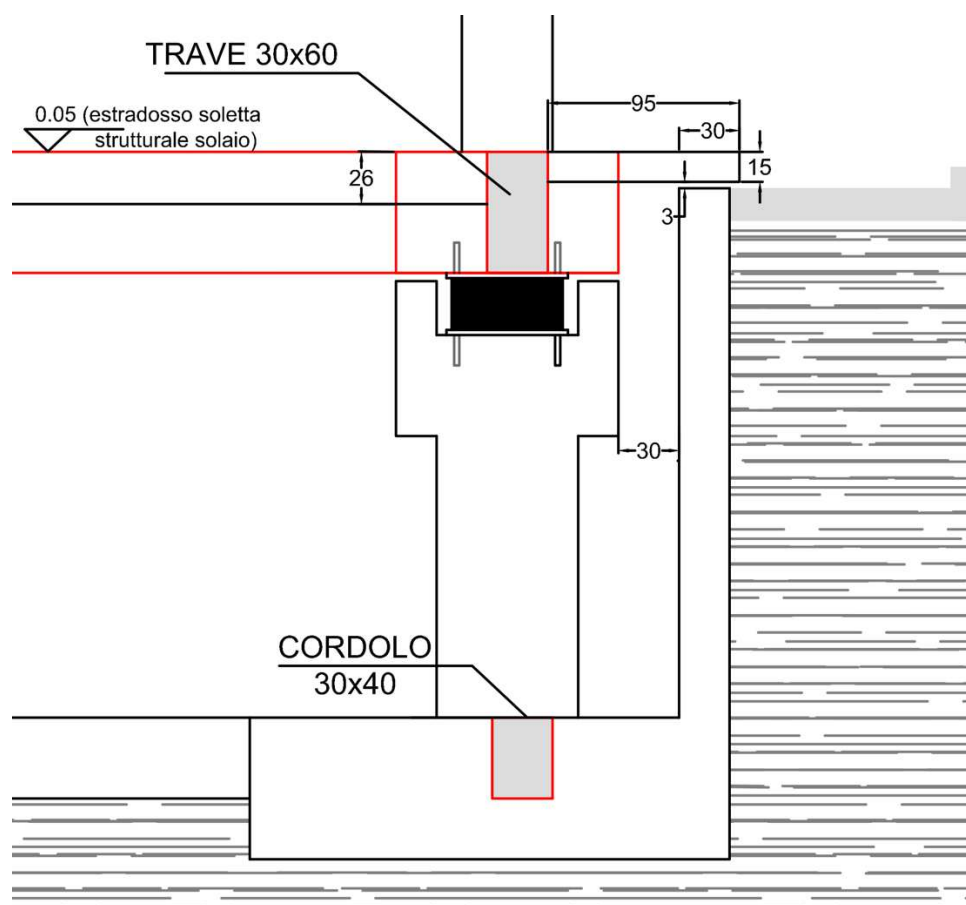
Dettaglio costruttivo: solaio a sbalzo.
